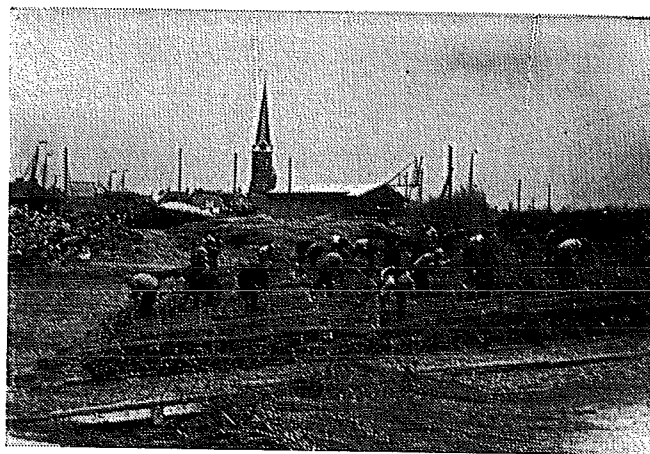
Hellende plankier of „kunstmatige zate” — in 1934 — bij de Zuiderzeewerken. (Foto Zuiderzeewerken.)
